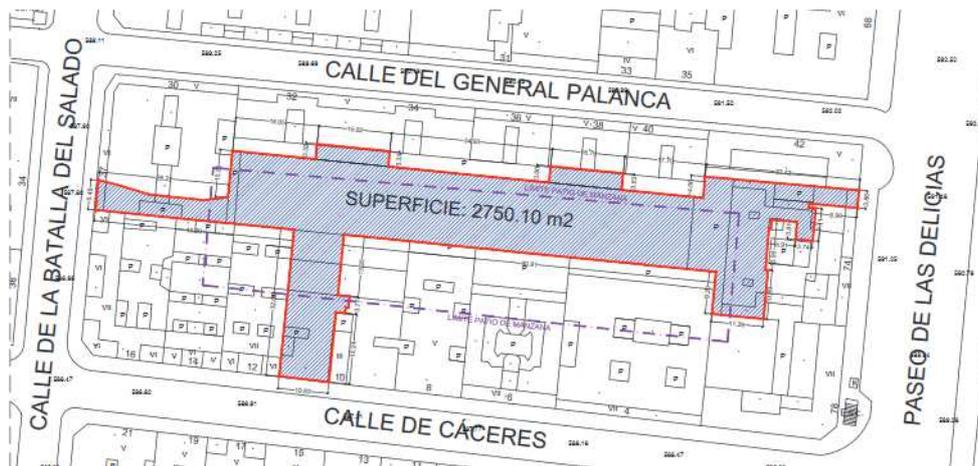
Ámbito del plan especial (planta baja) y alineación interior
